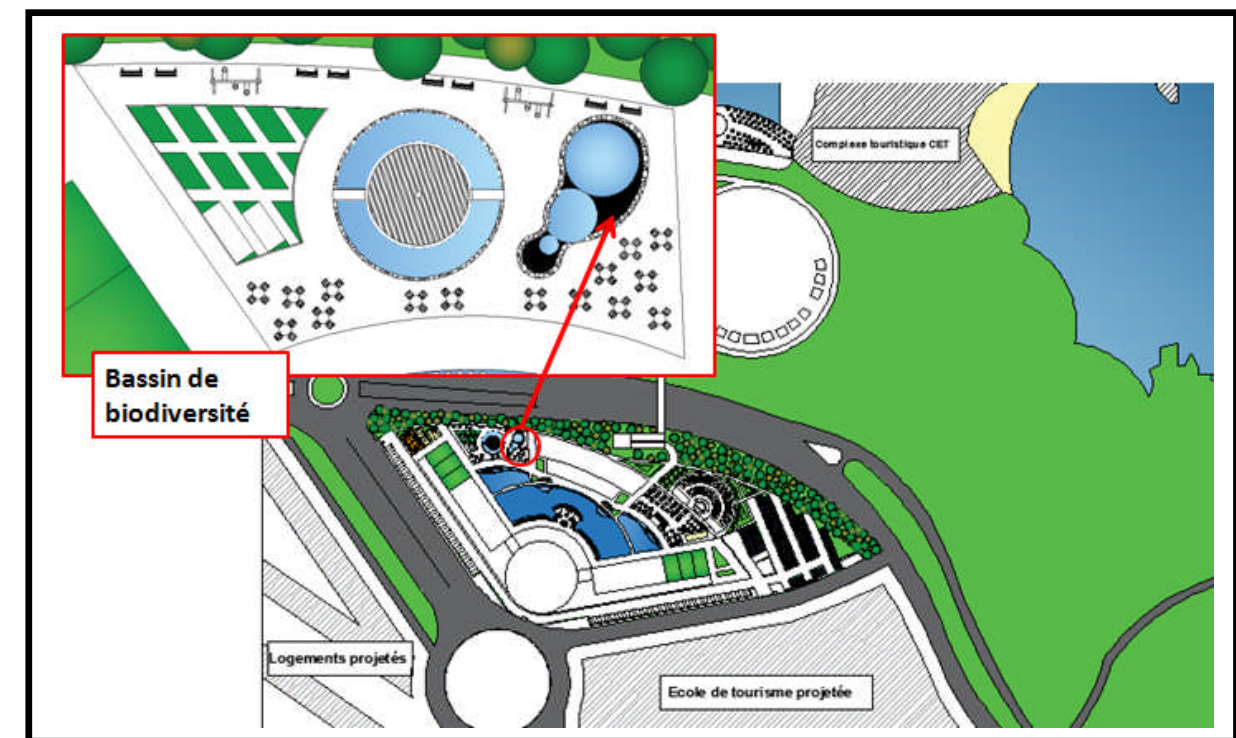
l'emplacement du bassin de biodiversité au niveau du plan de masse
